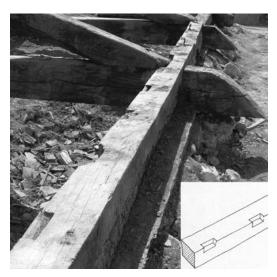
Nave lateral norte. Vista del estribo sobre el muro exterior con sus rebajes equidistantes. Estribo con rebajes para encastre de pares (Fernández Cabo 1997)
